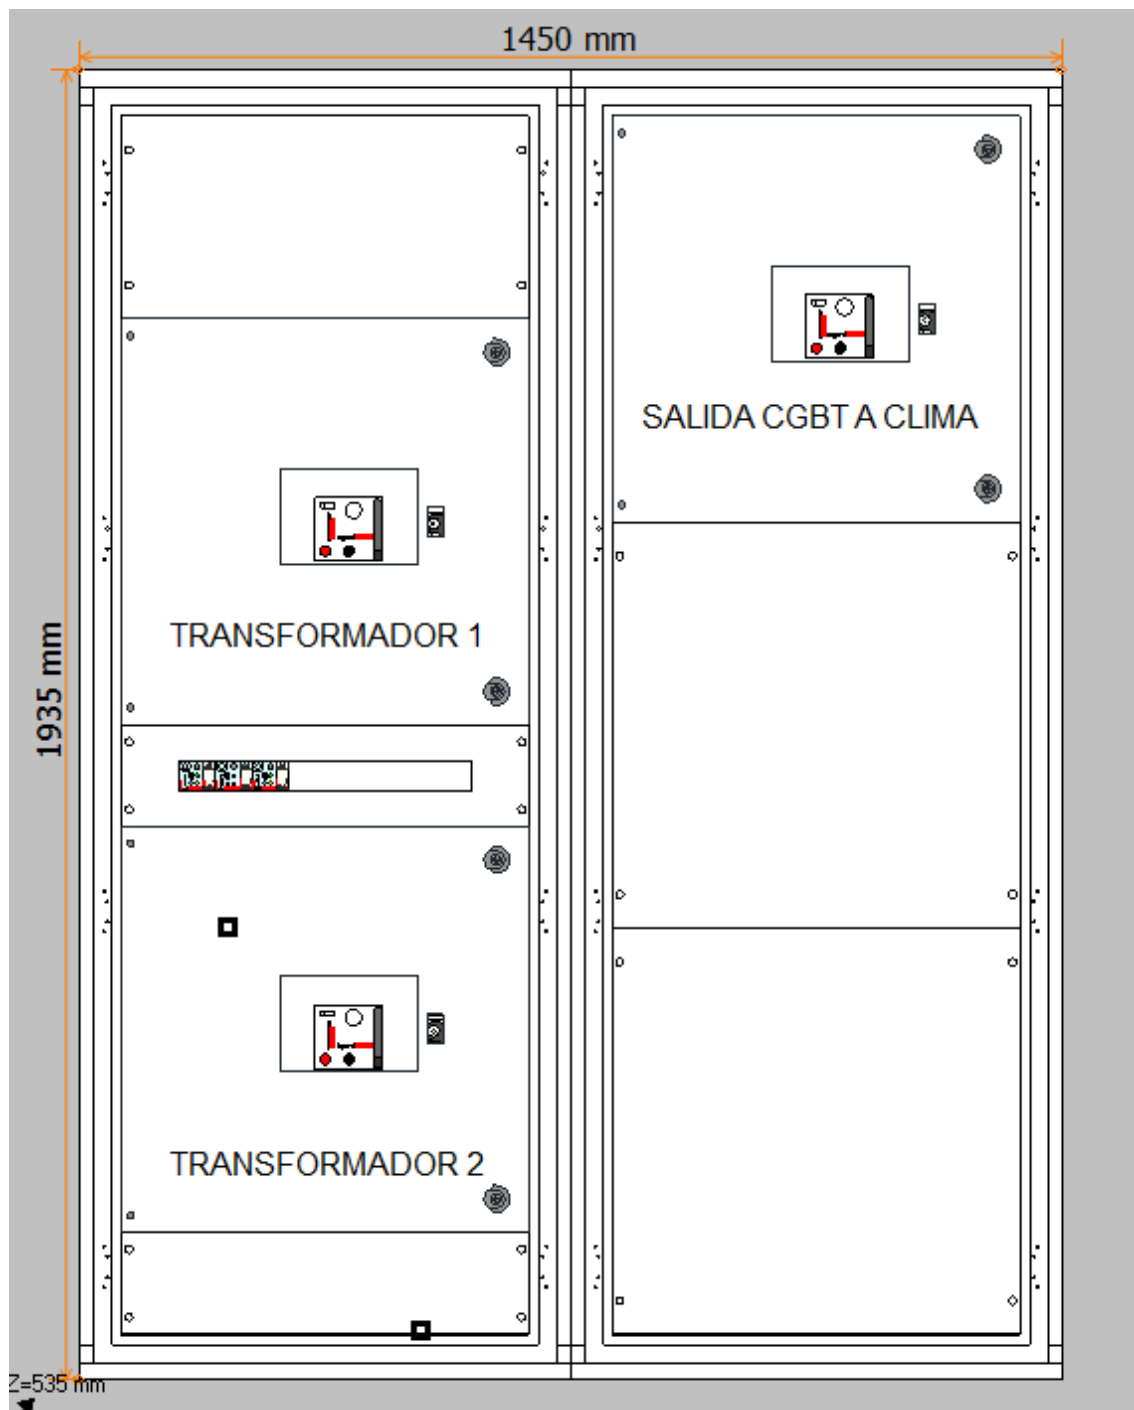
Alzado y planta del nuevo CGBT en el Edificio Prefabricado
